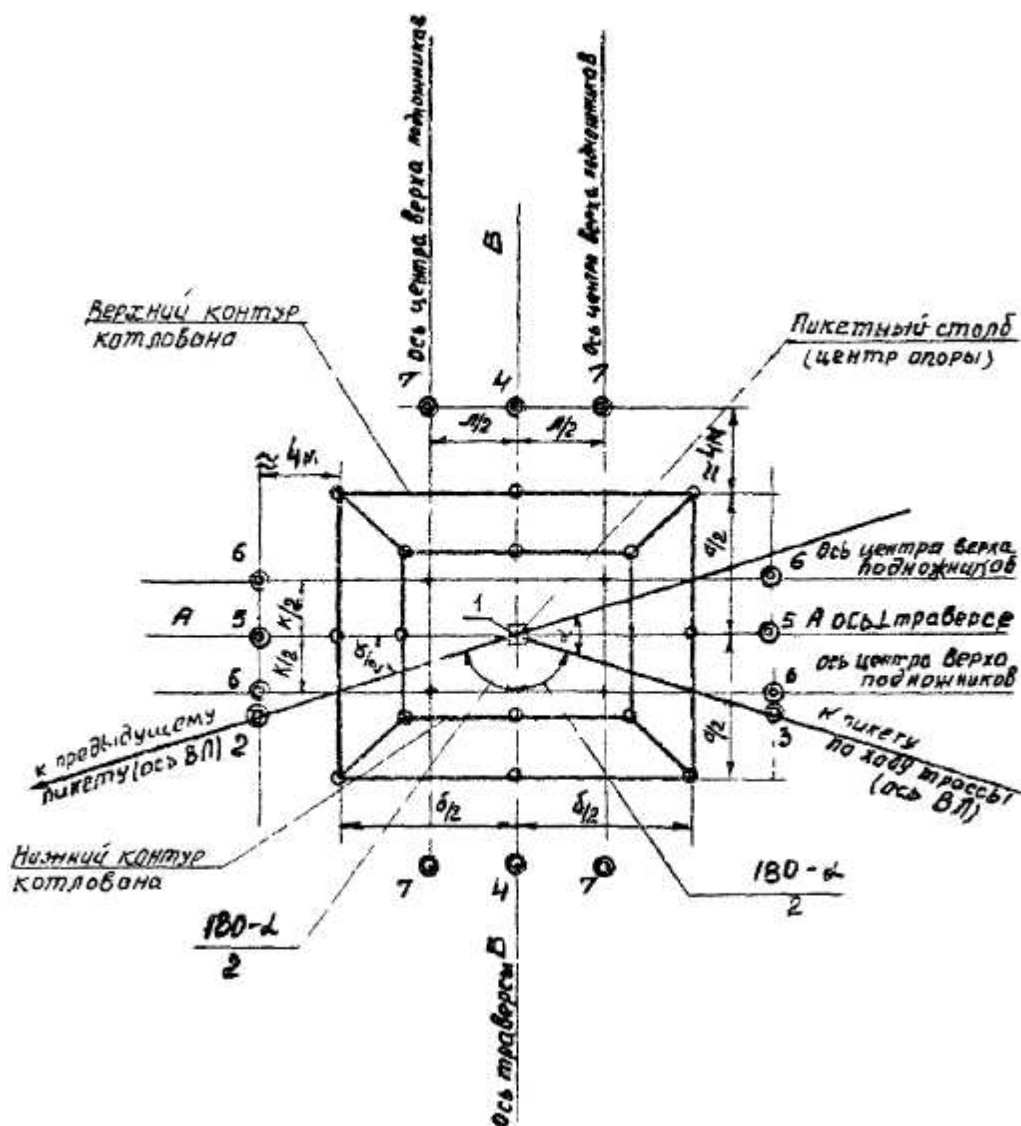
Допускаемые отклонения при разбивке котлована
